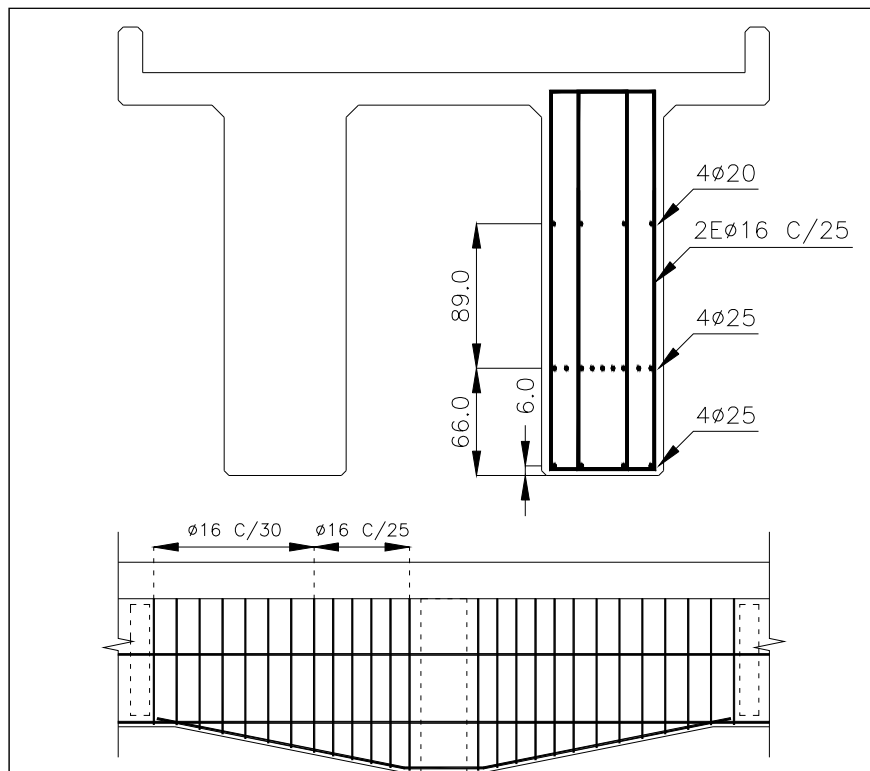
Esquema transversal e longitudinal das armaduras das vigas longarinas na região dos apoios sobre pilares (áreas 3 e 5).
